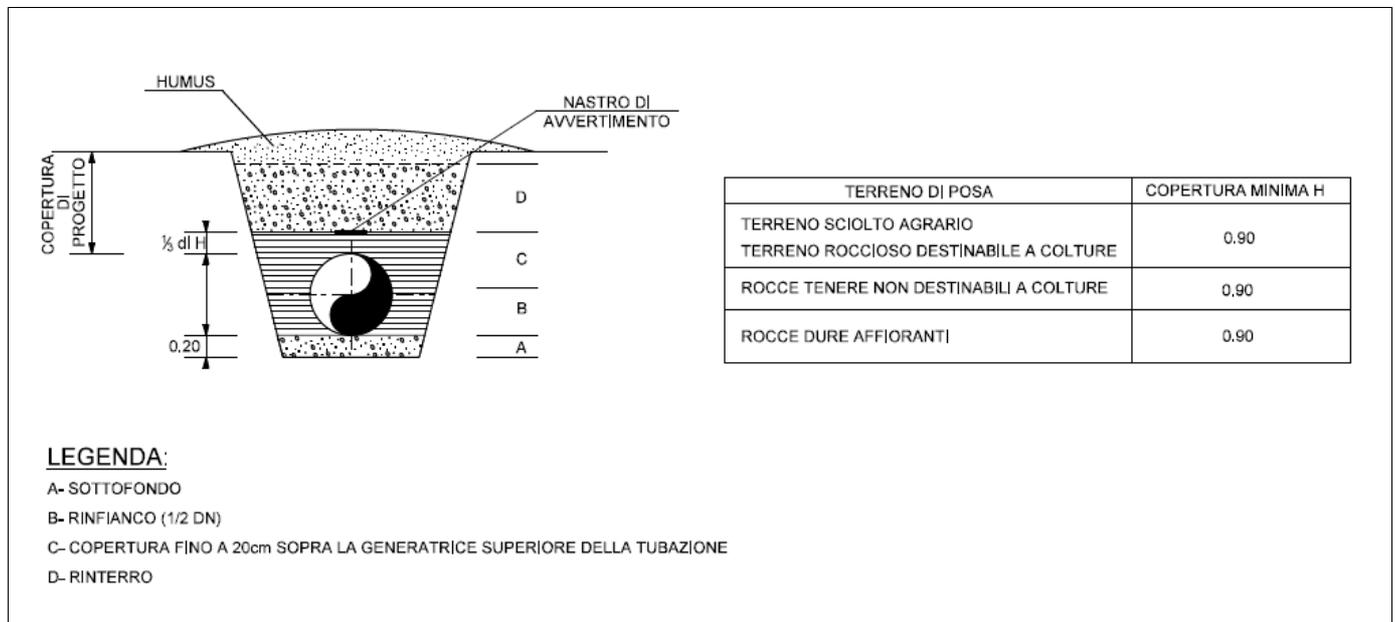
Sezione tipica della trincea di scavo per la posa della condotta
